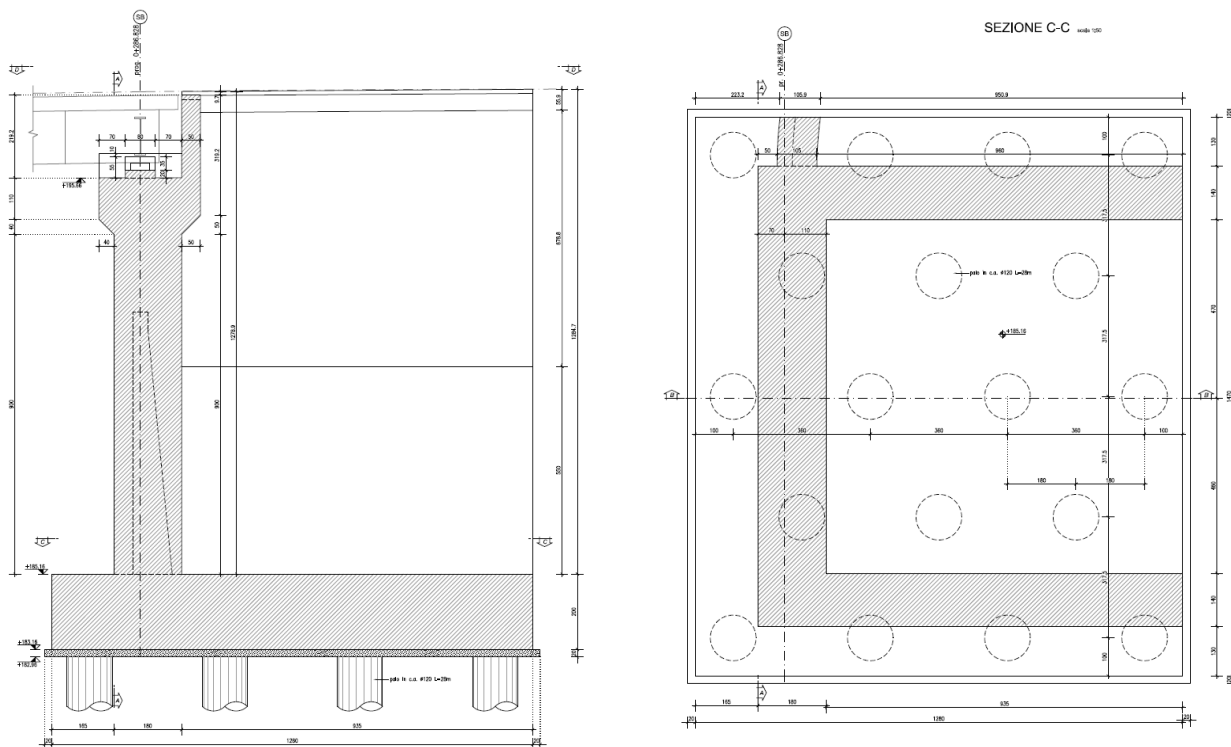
spalla B. sezione trasversale e pianta fondazione
